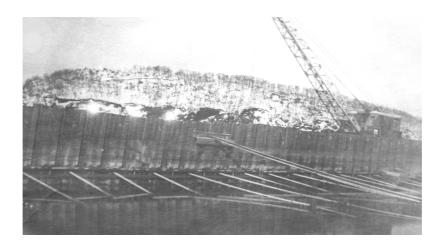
Шпунтовая конструкция перед засыпкой грунтом (из фондов КГБК ККОМ. ГИ 21195)
